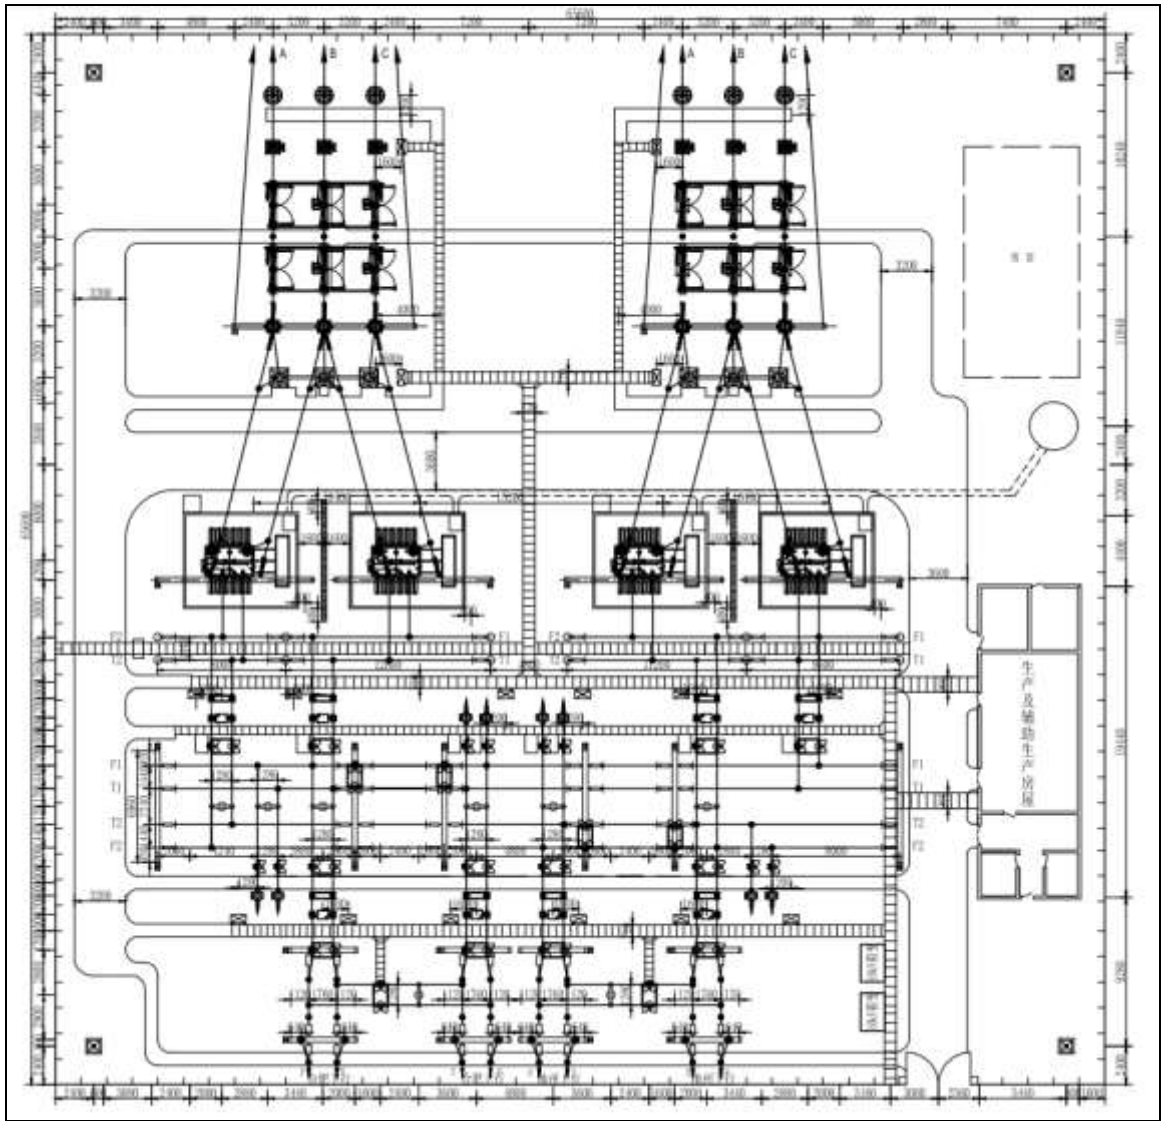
新建 220kV 户外牵引变电所总平面布置图
